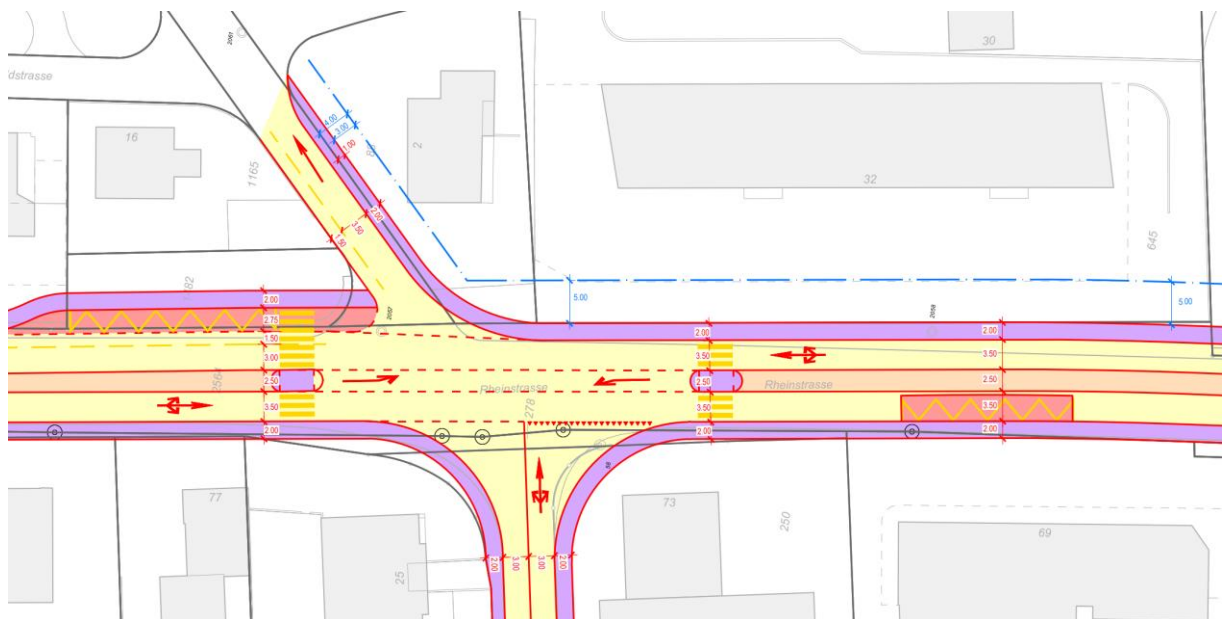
Projektplan Rheinstrasse (Stand September 2021)
